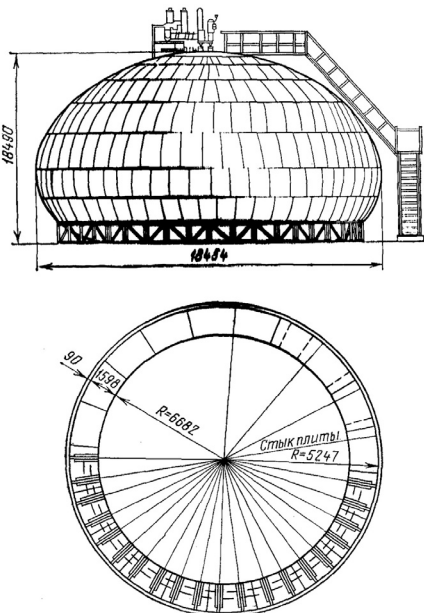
Каплевидный резервуар с опорным кольцом
